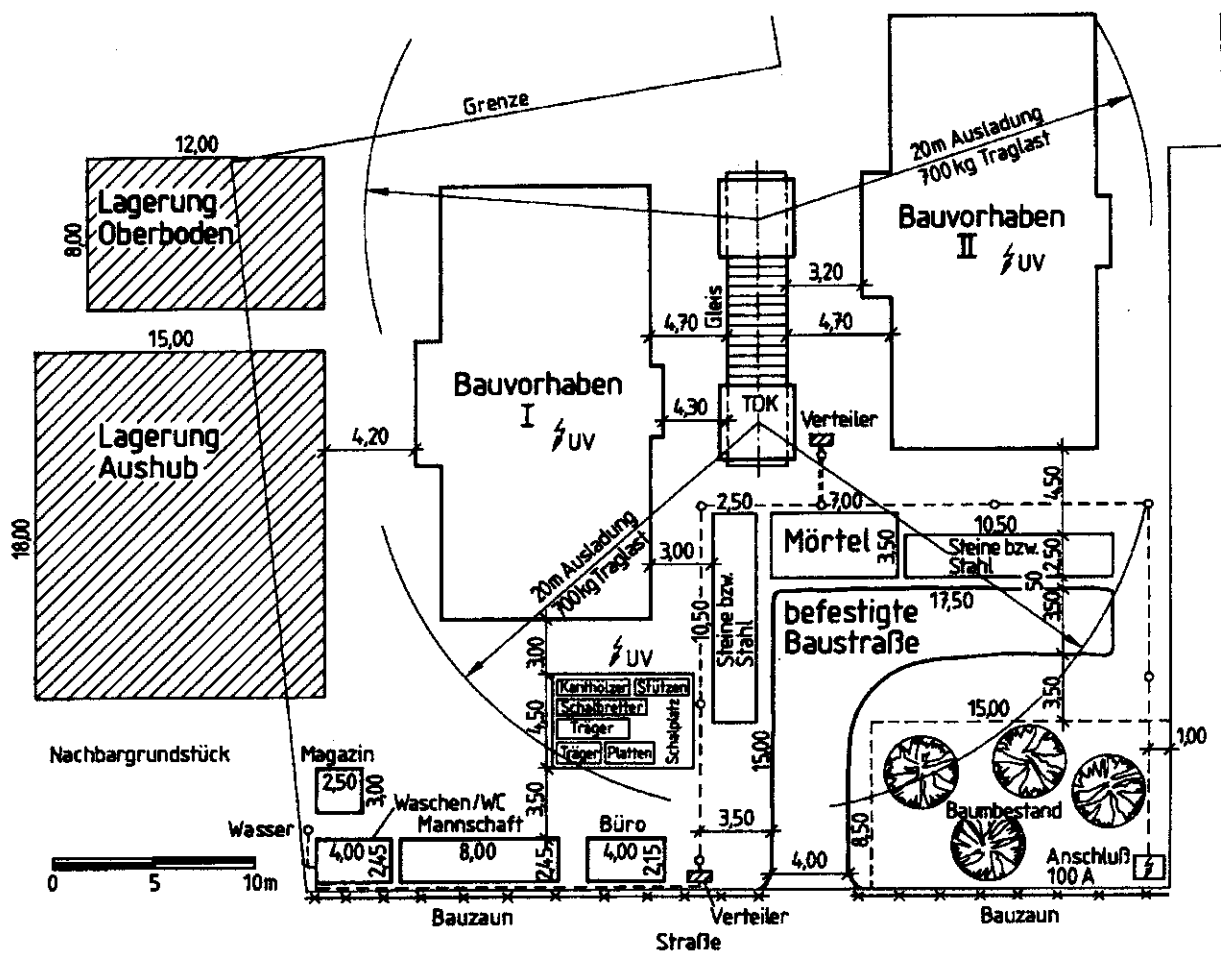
Baustelleneinrichtungsplan [Hoffmann/Kremer, 1992 -384-]
